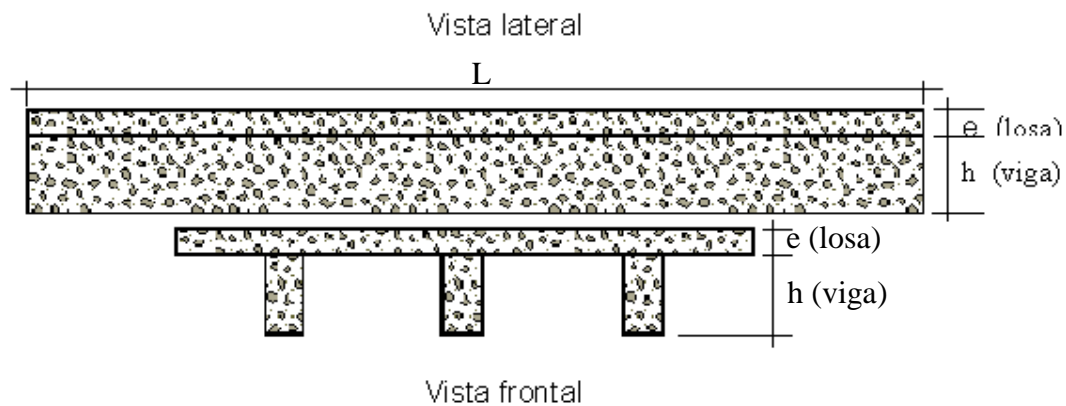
Puente con Vigas Longitudinales de Concreto Reforzado.
